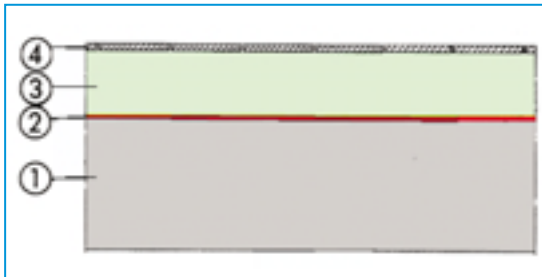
Bodenaufbau mit Abdichtung durch eine Dichtungsbahn:
